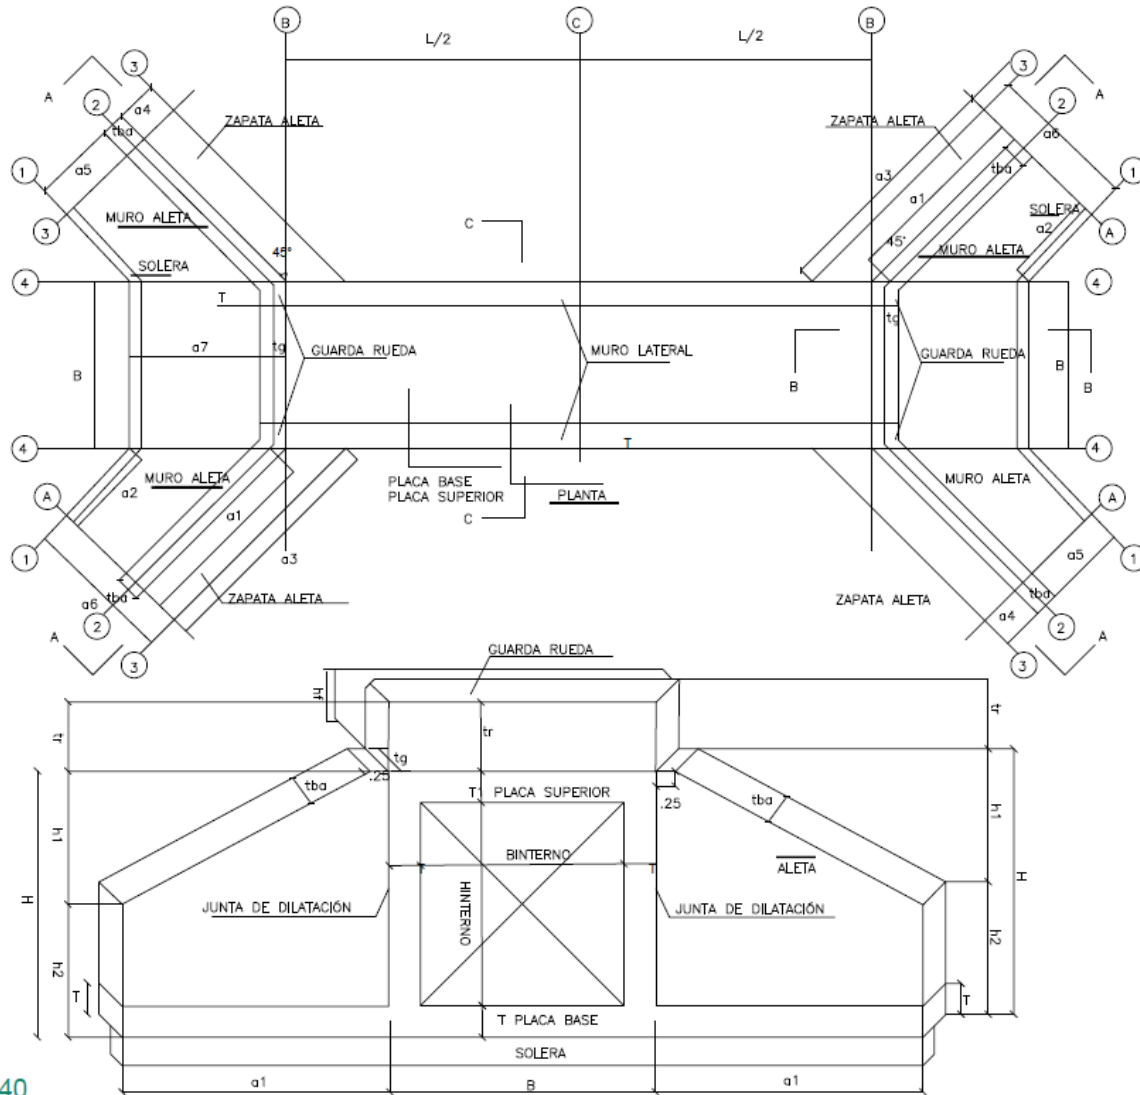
Box de dimensión 1.5 m x 1.5 m
